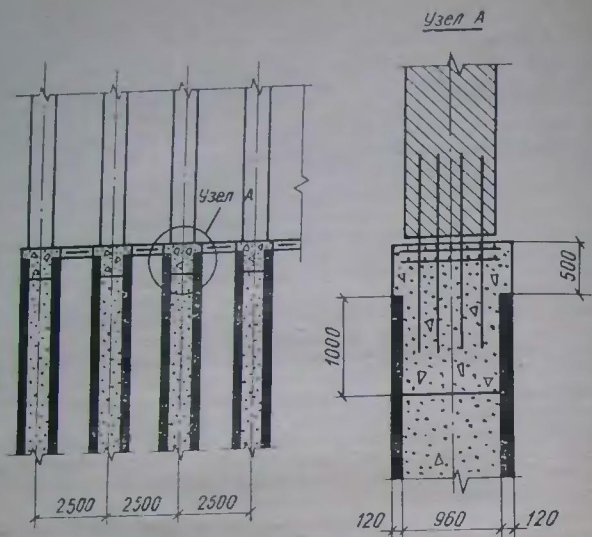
Конструкция опоры из одиночных свай-оболочек
